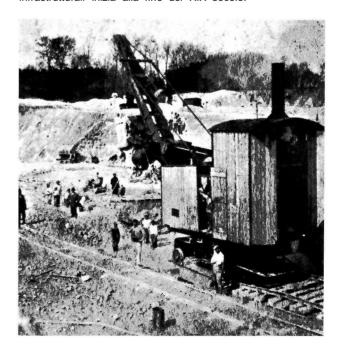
Un cantiere della ferrovia Londra-Birmingham (1836).
